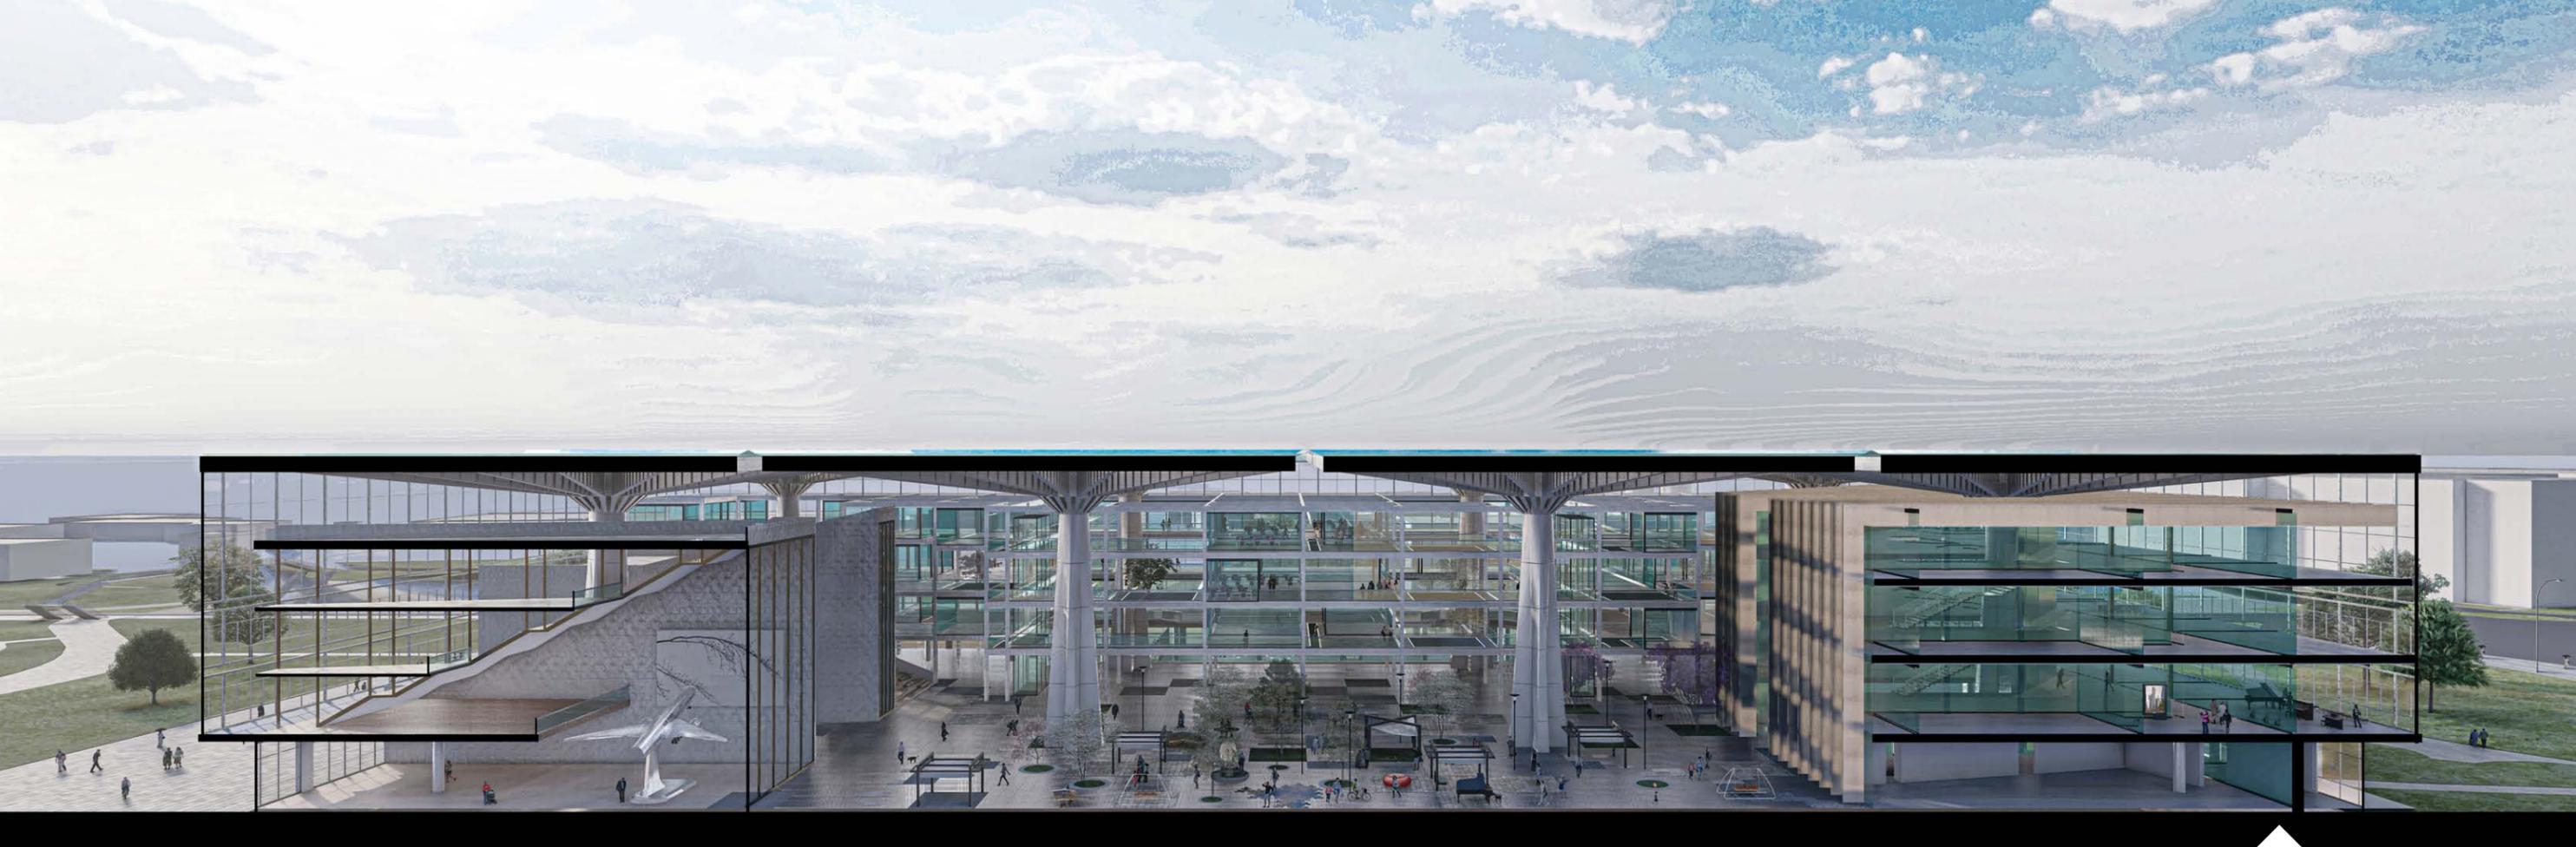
Sezione prospettica raffigurante il lato Science Center-Commerciale, elaborato degli autori.
